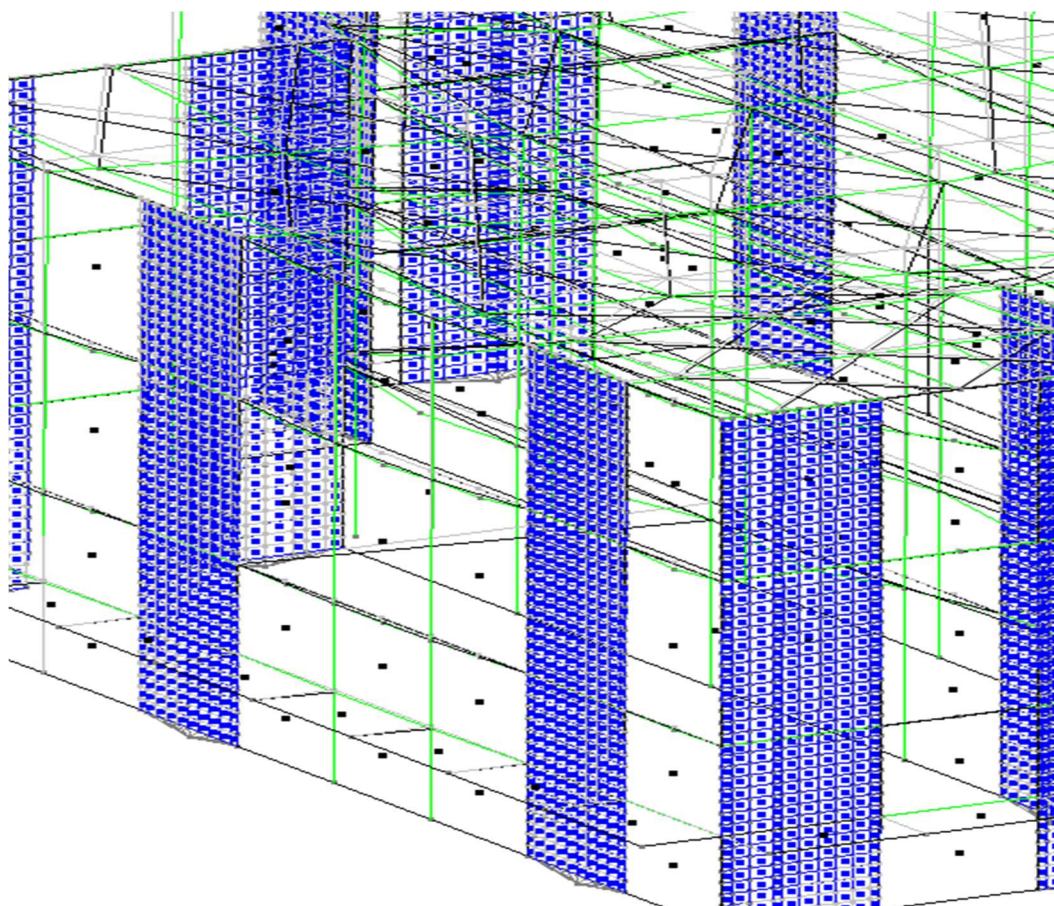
Deformata sotto pesi degli elementi NON strutturali.
